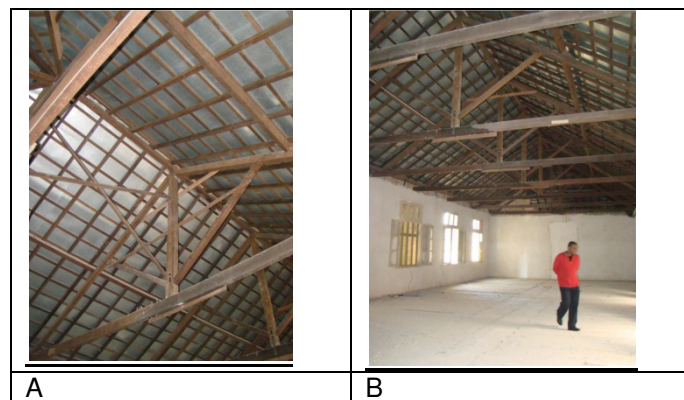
A, B. Placas galvanizadas instaladas abaixo do telhado.
